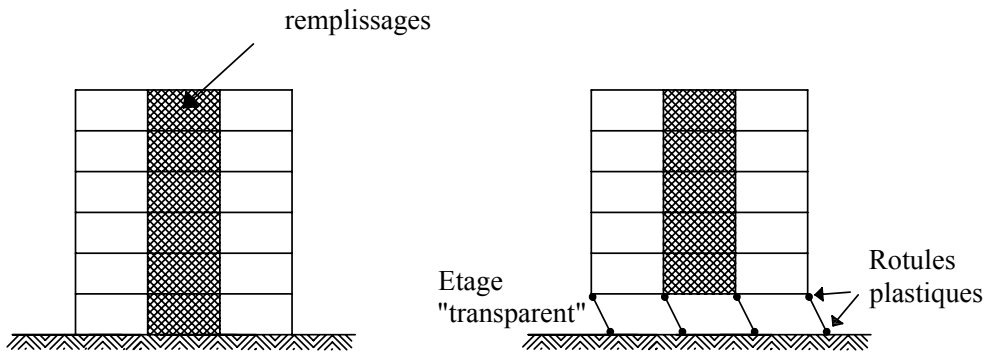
A gauche : régularité en élévation. A droite : niveau rez flexible ou "mou" (anglais : soft).
